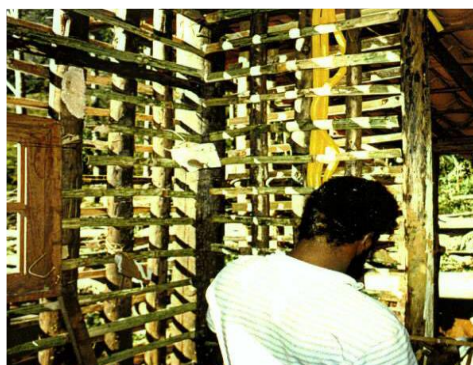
Colocação das madeiras horizontais da malha interna. Foto de INO e LOPES, 2004.
